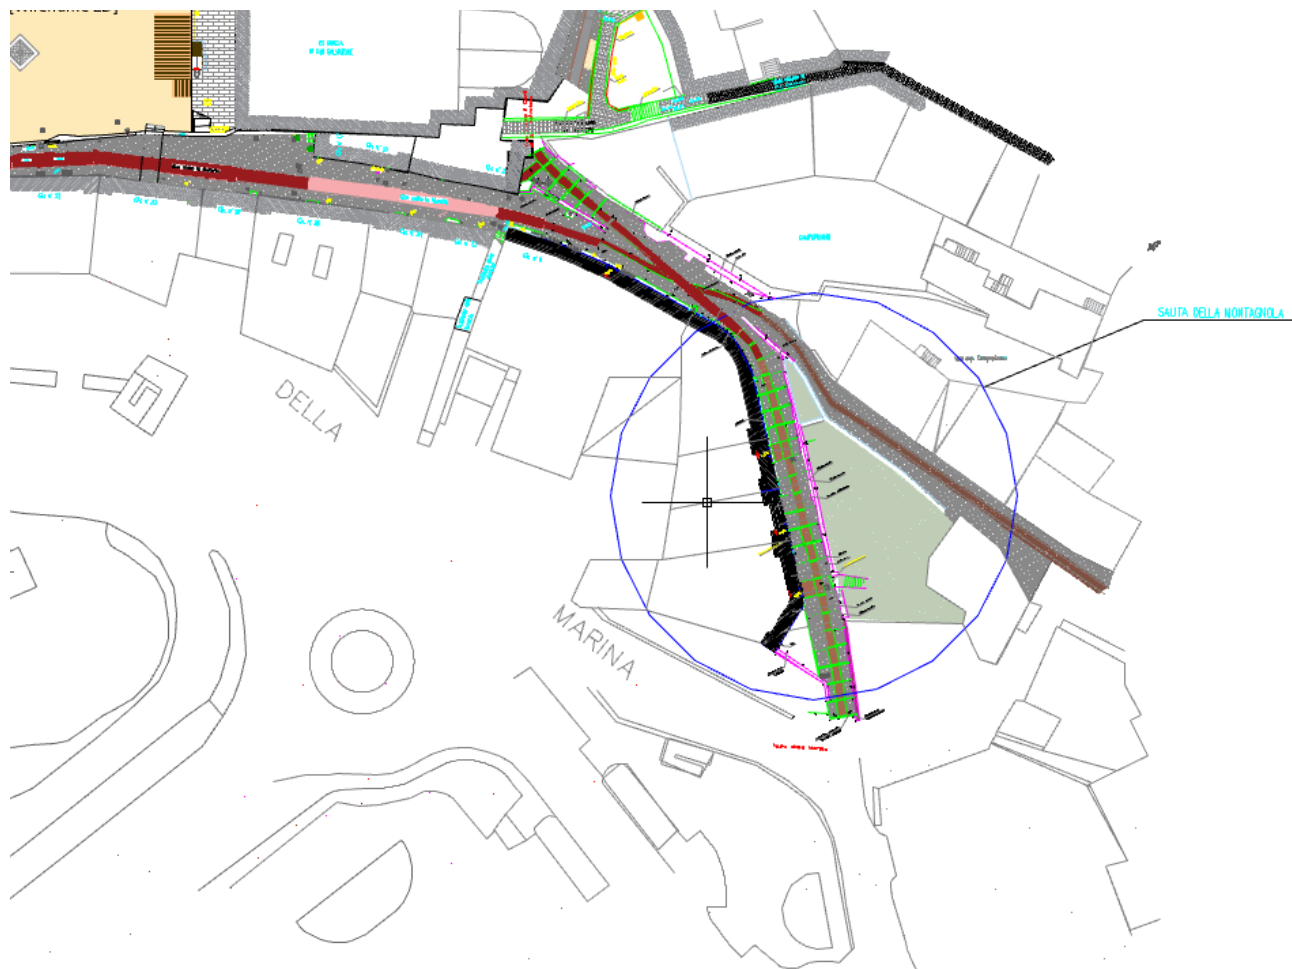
Stralcio planimetria tratto di salita della Montagnola
